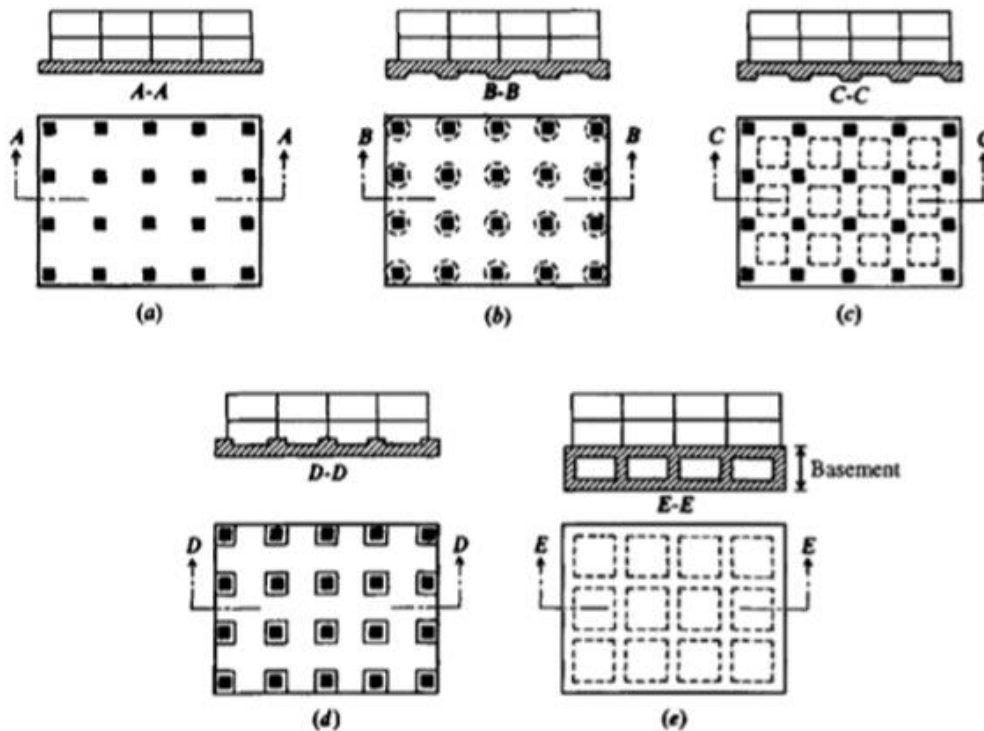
Tipos de ensoleiramento: a) flat plate; b) plate thichened under columns; c) Waffle-slab; d) plate with pedestals; e) basement walls as part of mat. (Bowles, 1996)
